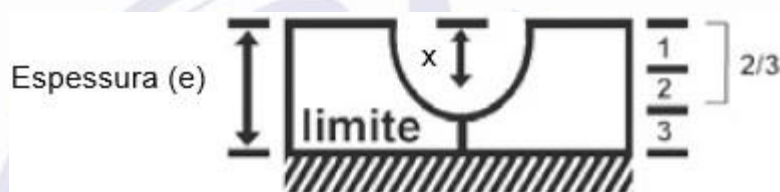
Profundidade da cavidade de fresagem nas emendas entre as mantas a serem soldadas com cordão de solda
